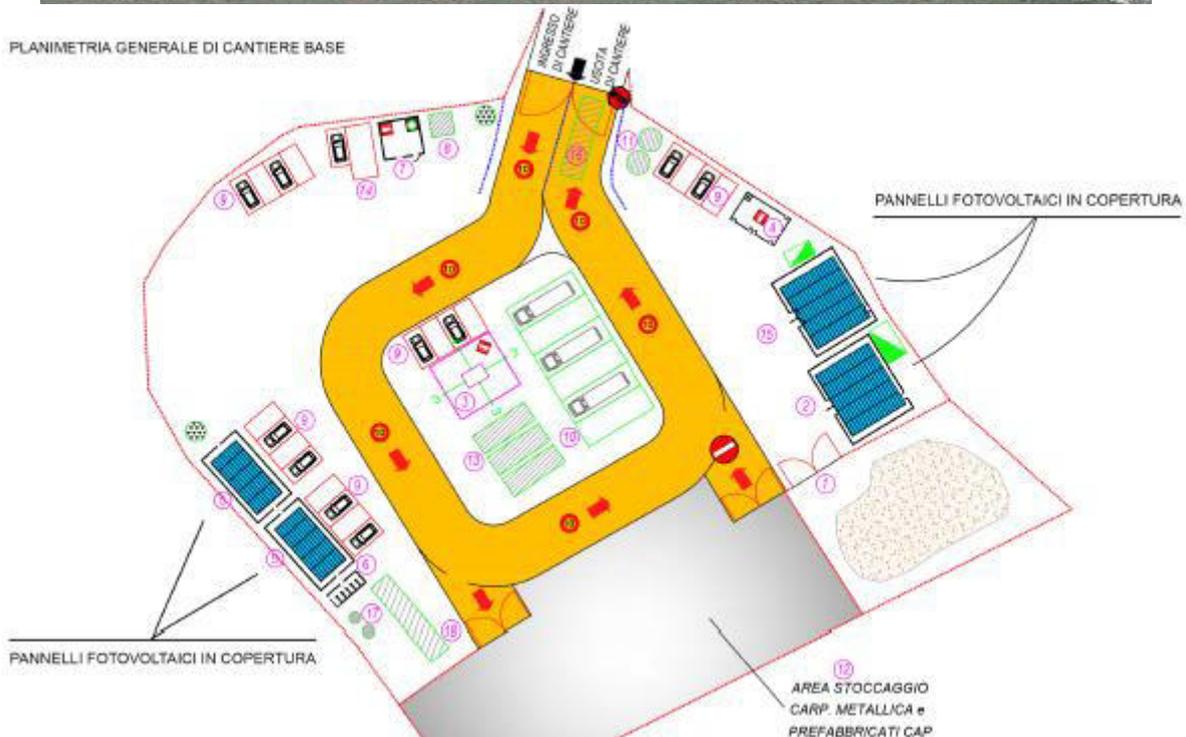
Layout area di cantiere n° 1 – alimentazione energia elettrica
